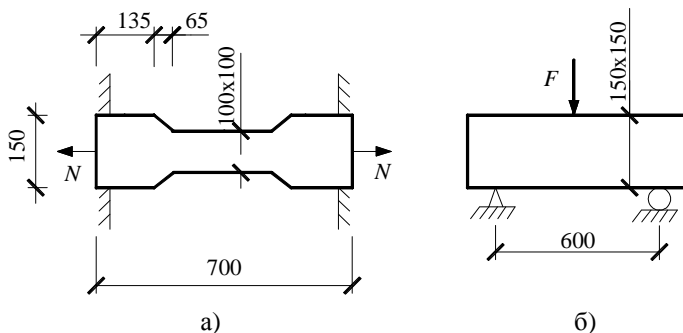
Схеми випробувань зразків для визначення міцності бетону на розтяг:
